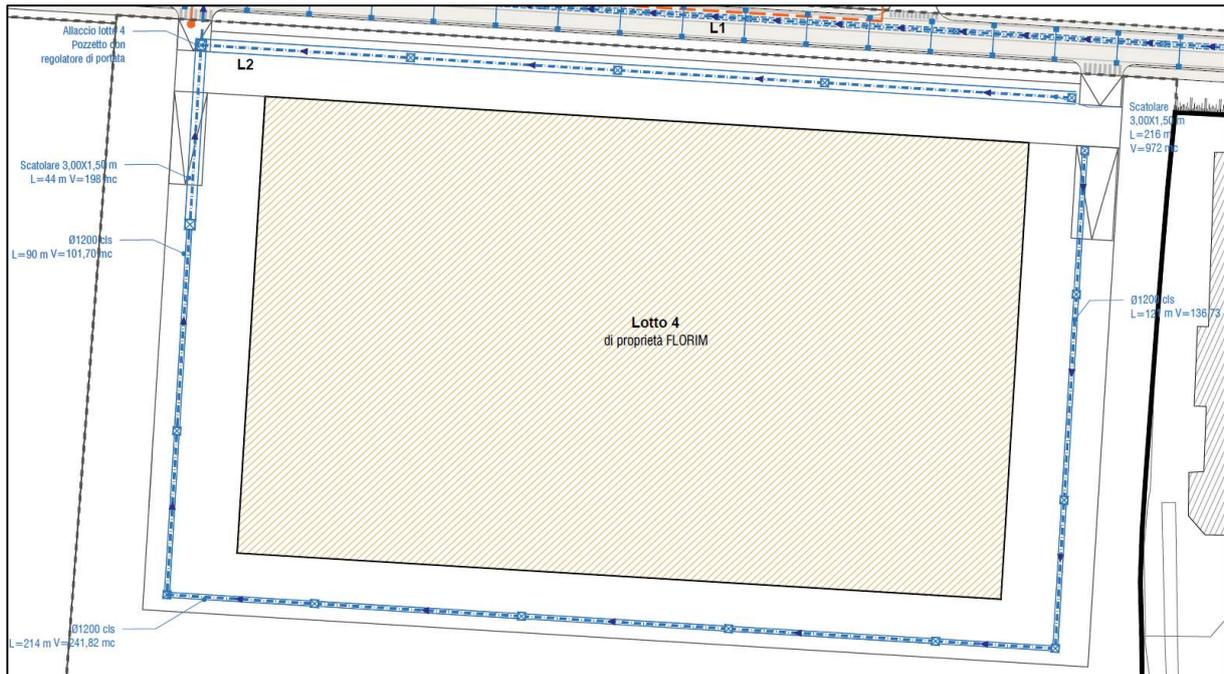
Planimetria di progetto del sistema di laminazione del comparto Florim, costituito da condotte sovradimensionate e scatolare di contorno al futuro edificio.
